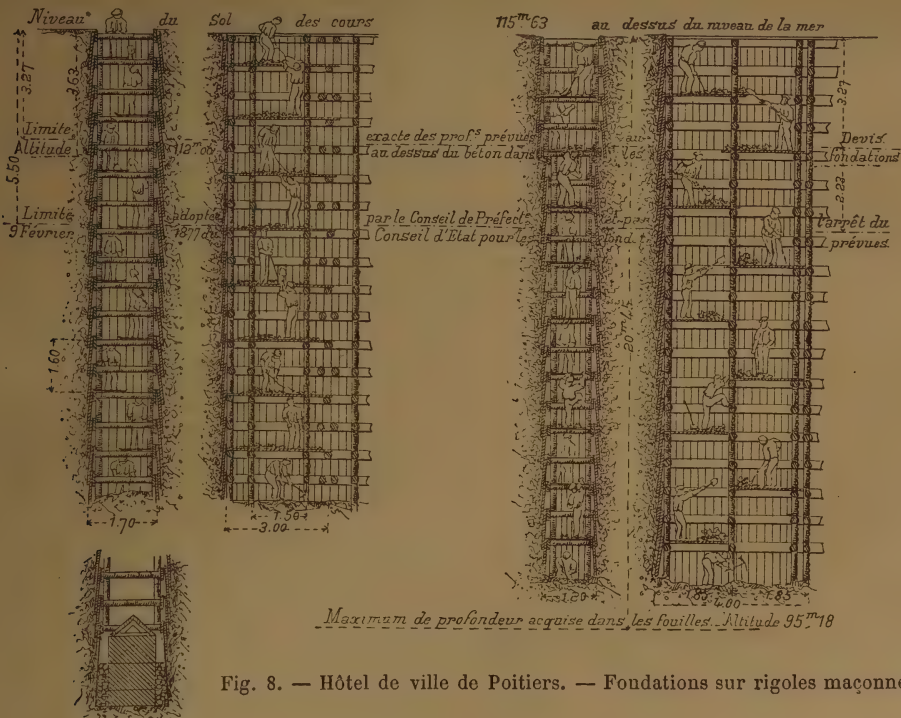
Hôtel de ville de Poitiers. — Fondations sur rigoles maçonnées.
